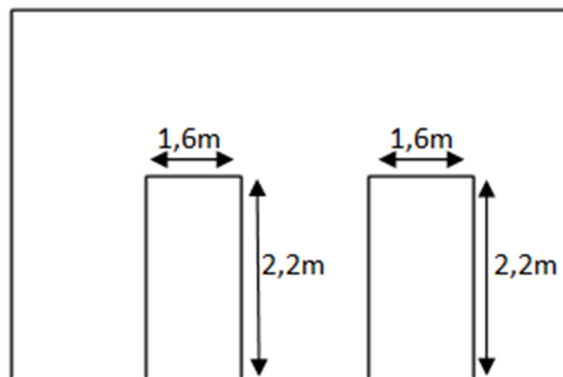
surfaces des ouvertures sur la façade latérale droite.
